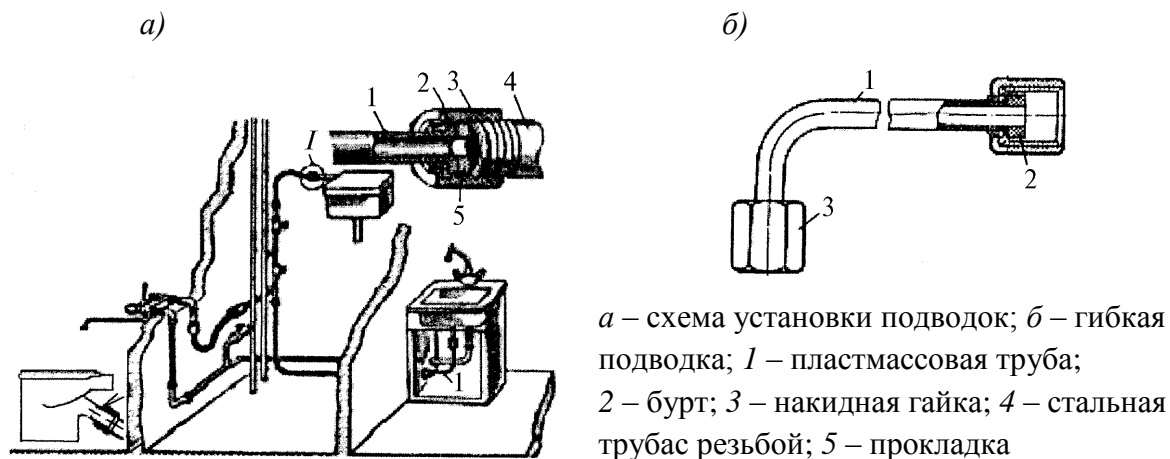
Гибкие подводки и крепление арматуры
